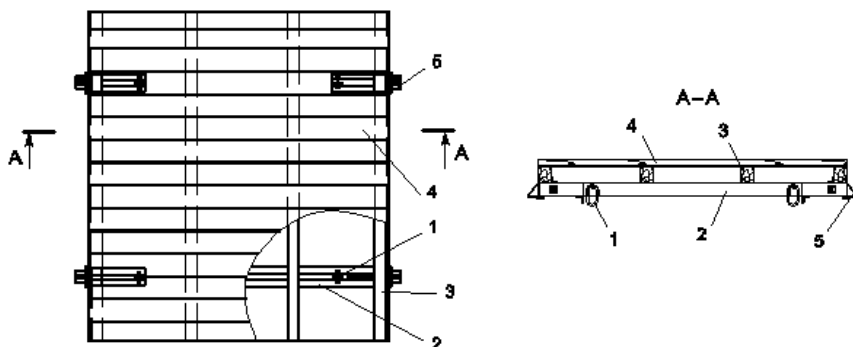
Схема укрупнительной сборки рабочей площадки опалубки лифтовых шахт:
